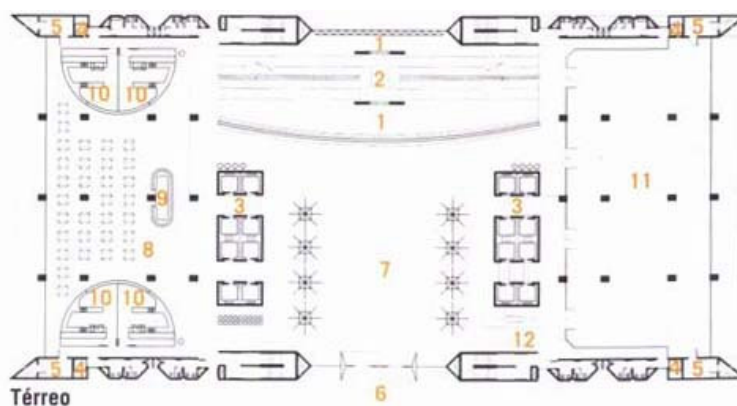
Planta do pavimento térreo (Fonte: Décio Tozzi Arquitetura)
